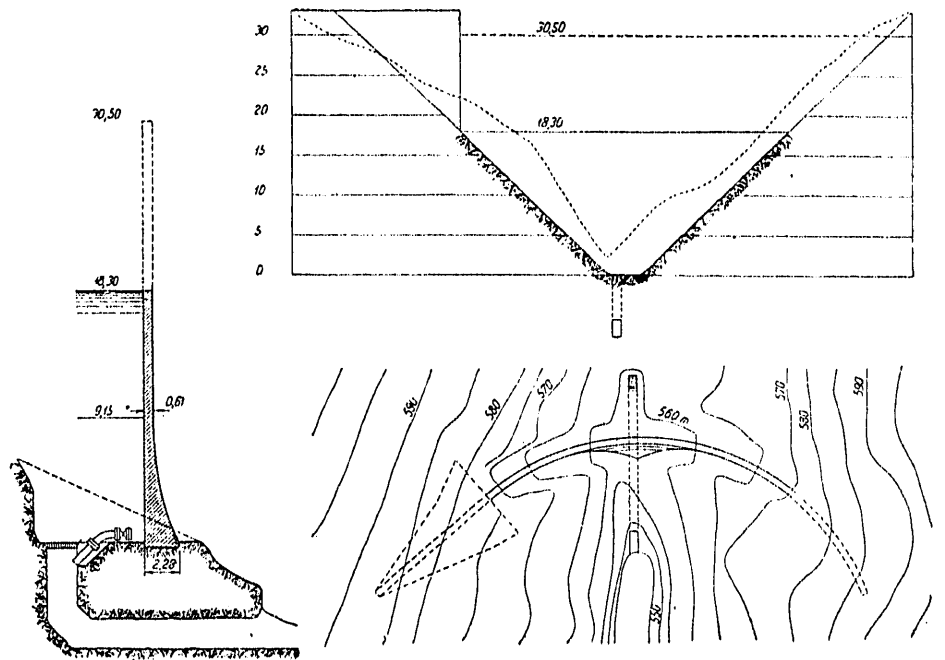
Planta, alzado en desarrollo y sección transversal de la presa de Stevenson Creek.
